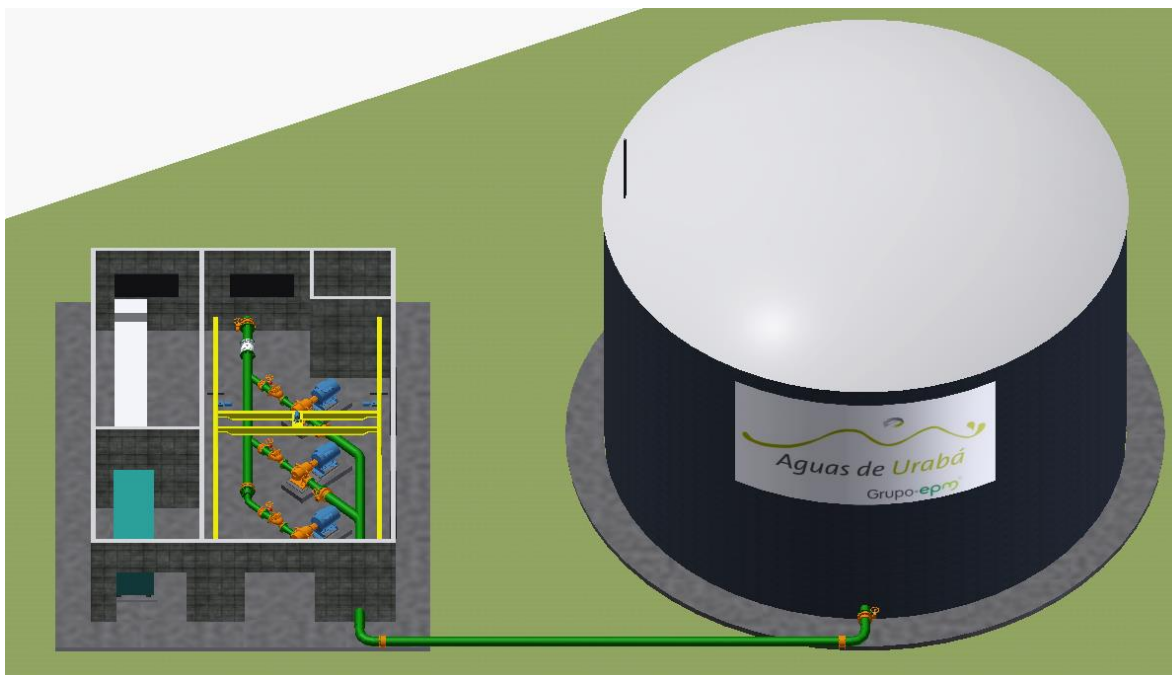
Esquema general frontal elevado de la instalación de rebomdeo
